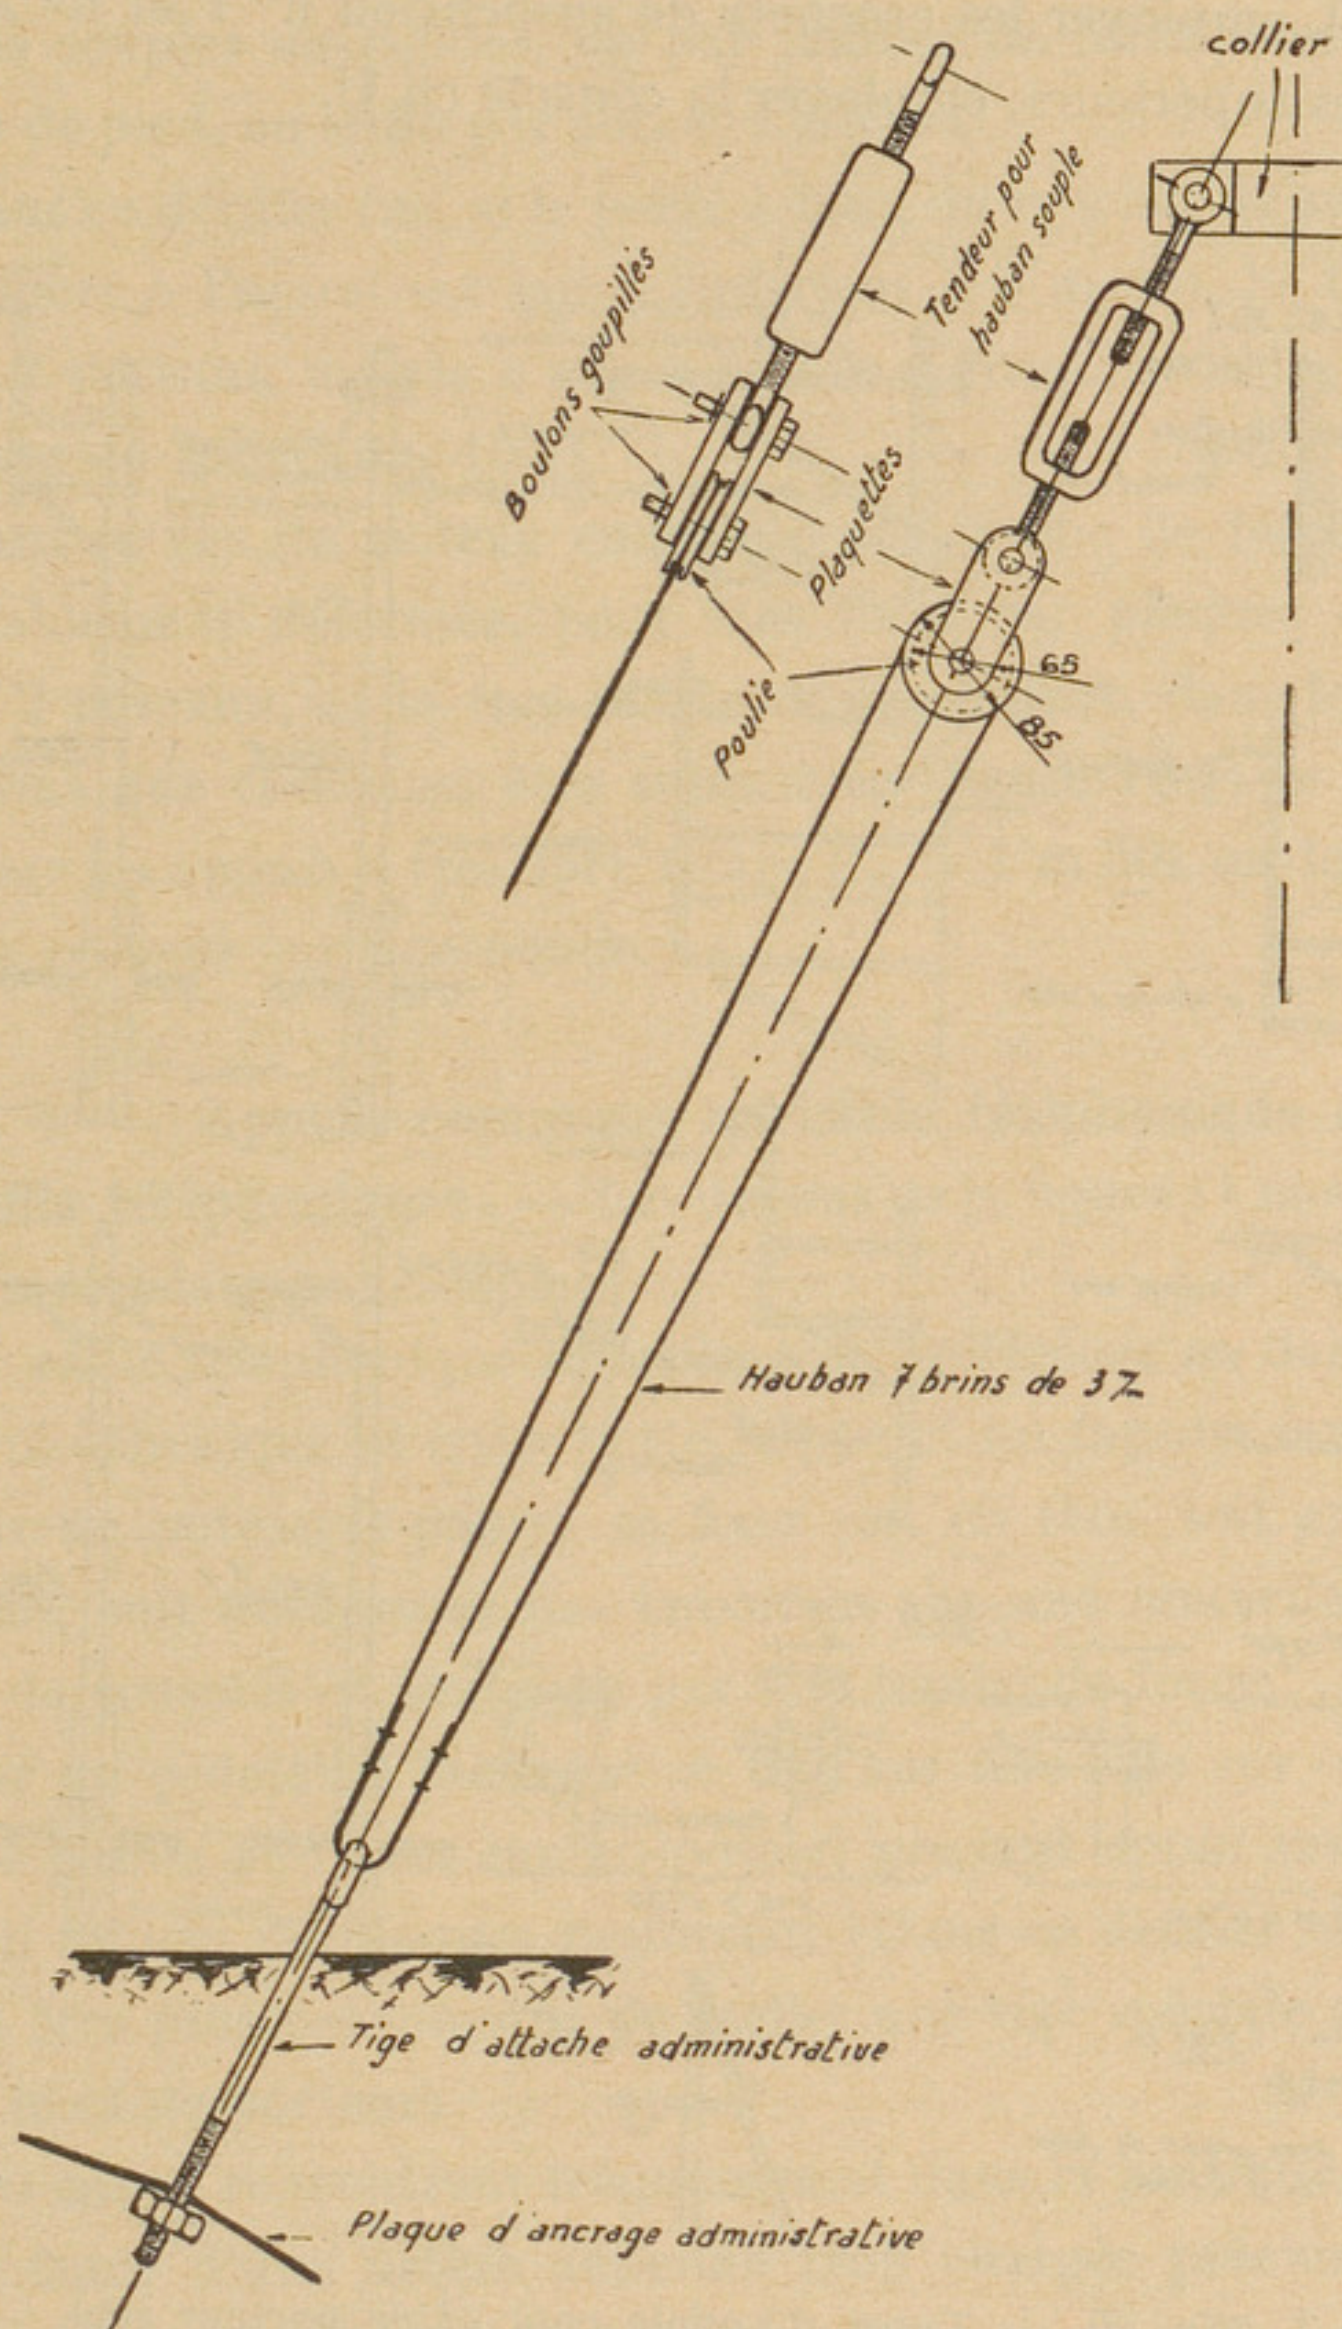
Montage d'un hauban : cas d'utilisation de hauban souple.
